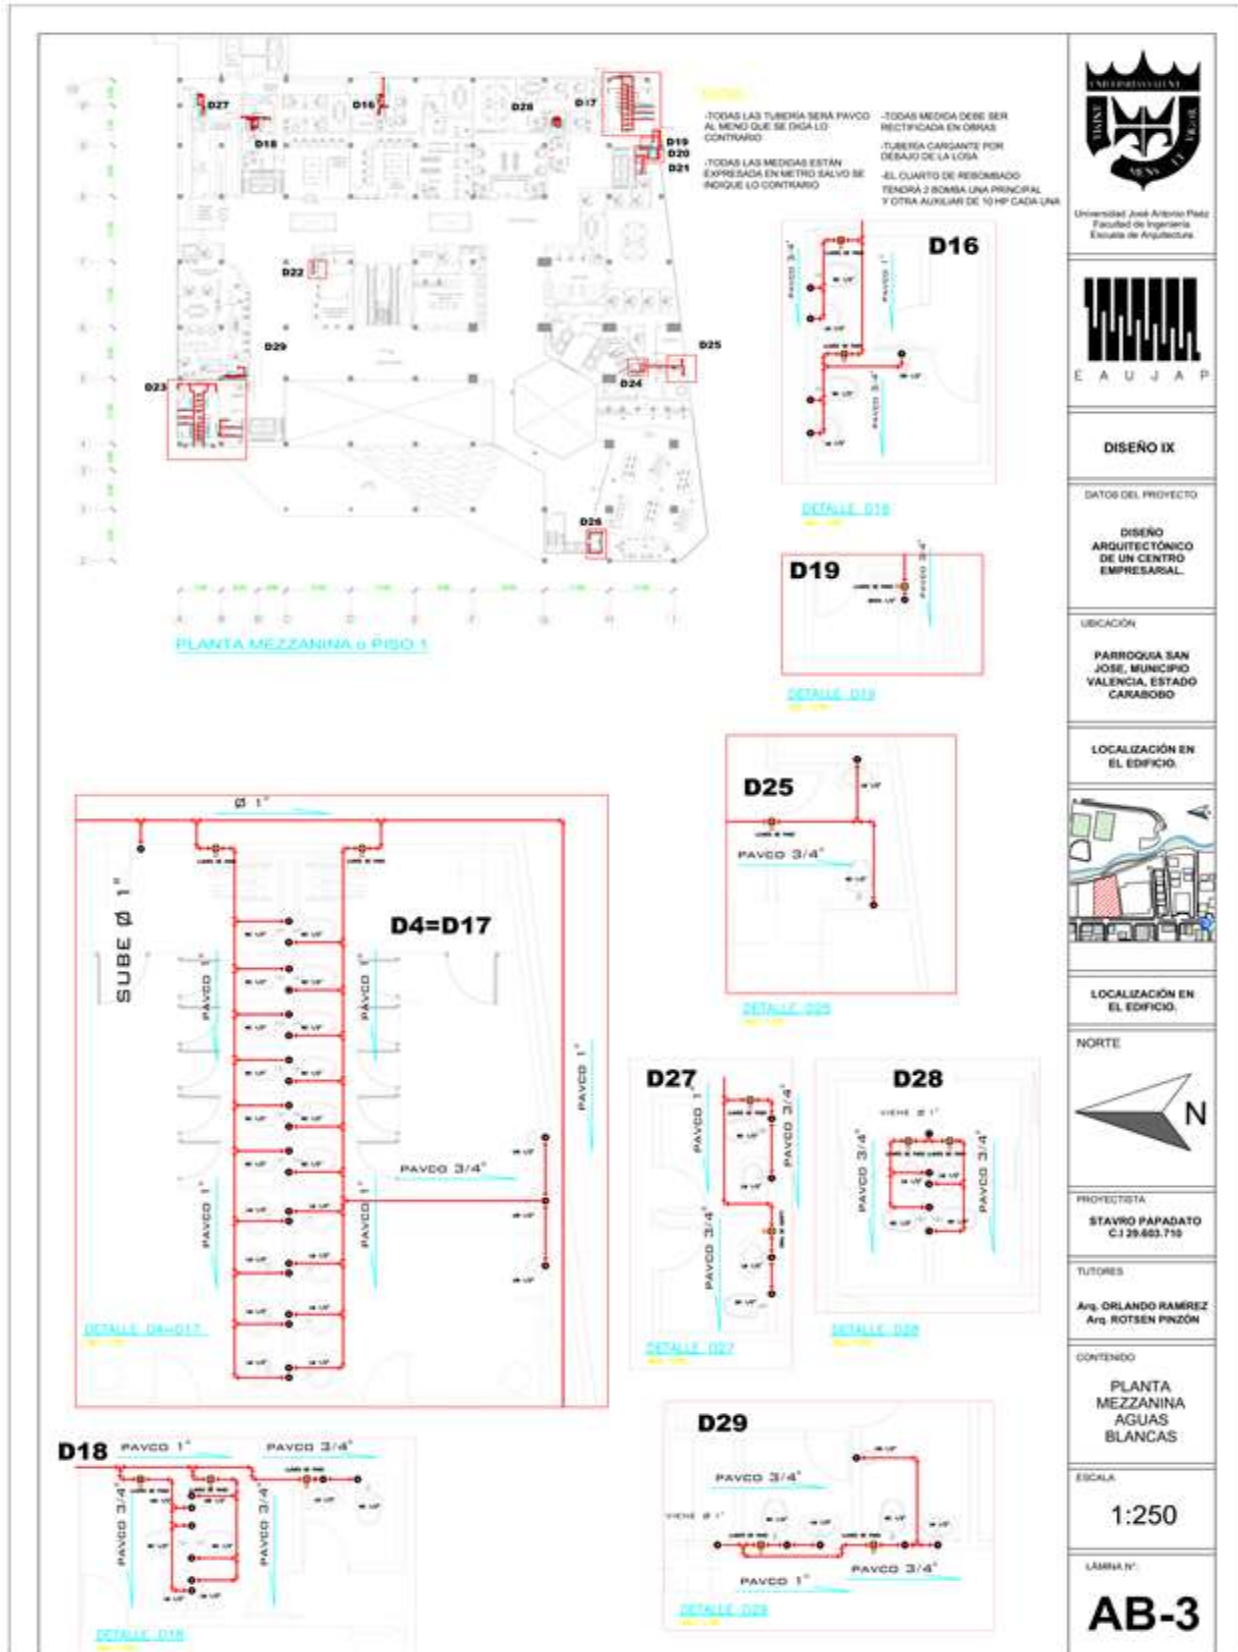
AB-3 Planta Mezzanina Aguas Blancas. Fuente: El Autor (2023)
